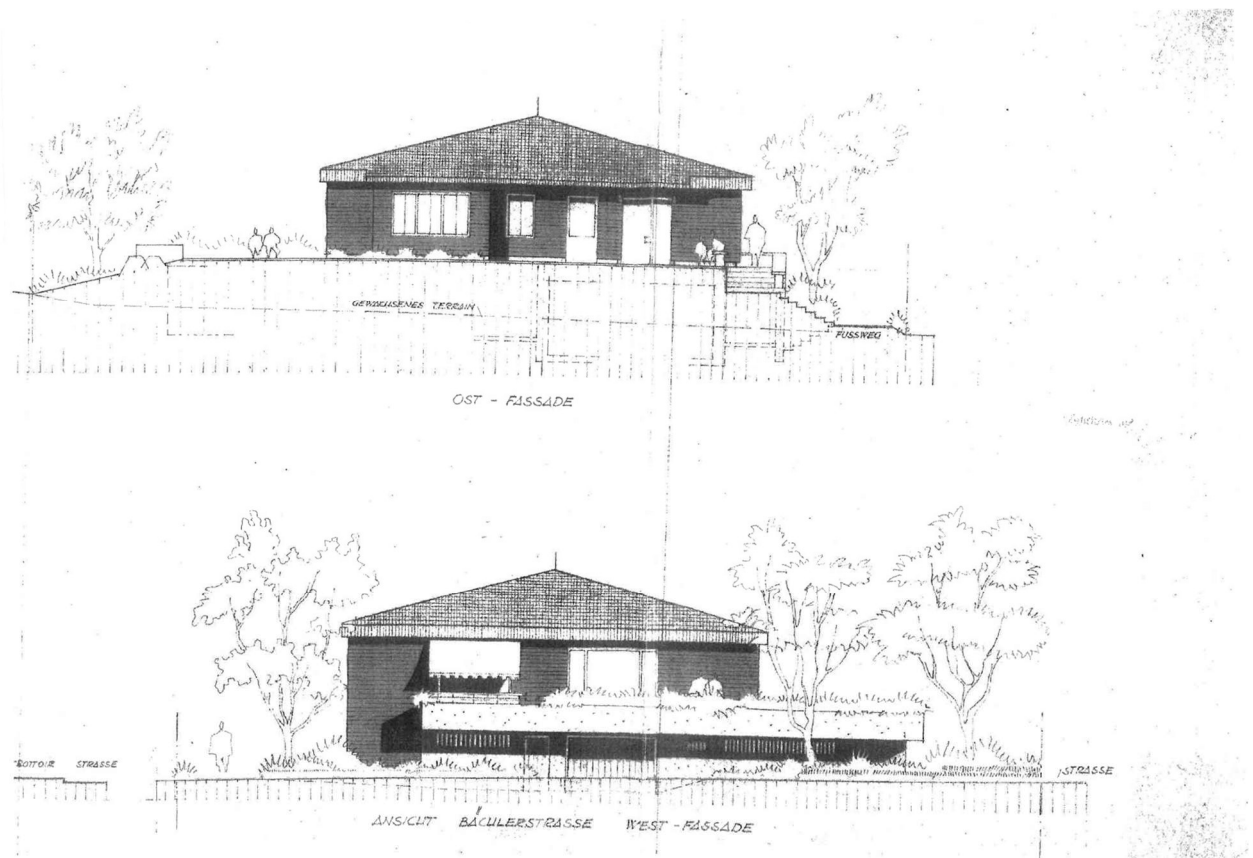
Fassadenpläne Kindergarten Bächler 1967, A.Binggeli Arch. Kilchberg, Fassadensanierung 1989, Hans Stocker Architekt Zürich
